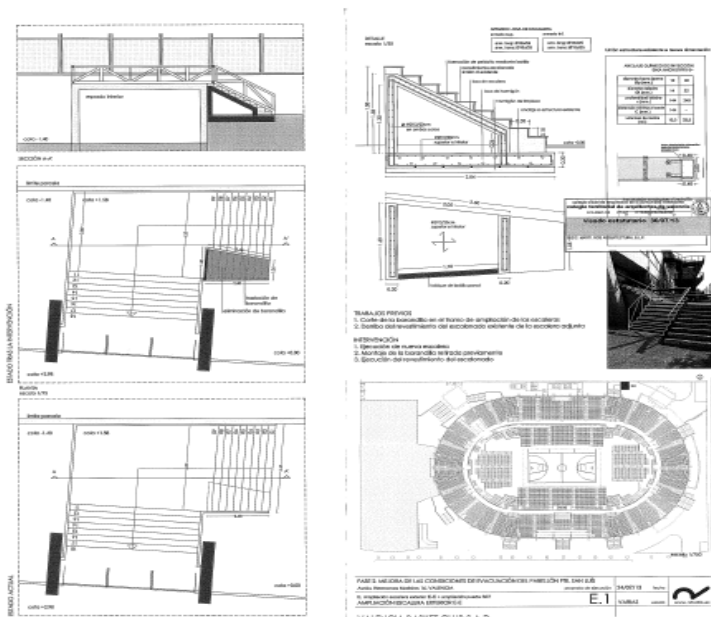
Plano de Escalera E-E Ampliación. Plano 31.
